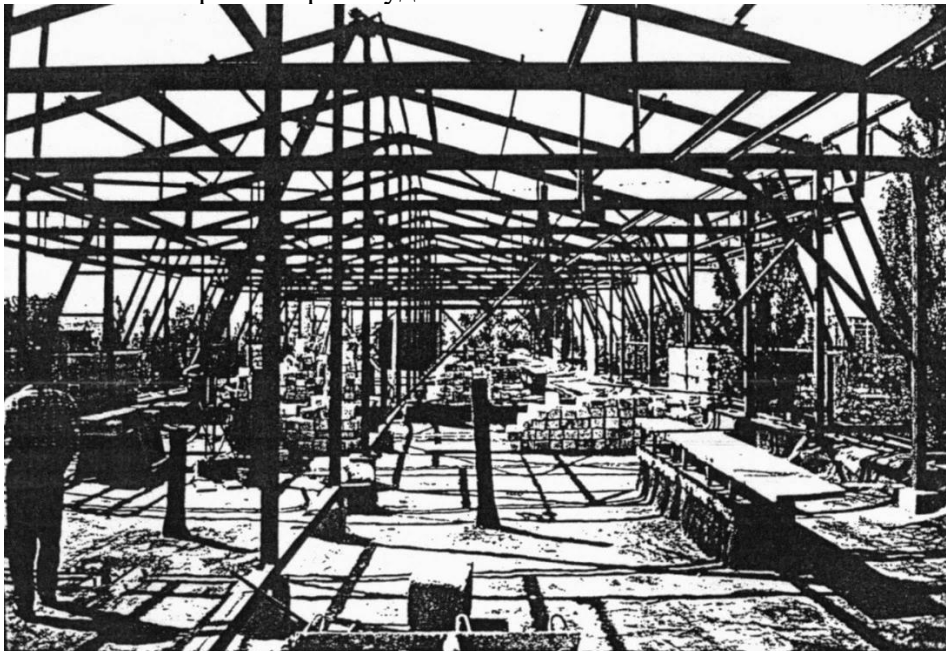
Загальний вид змонтованої частини металевих конструкцій мансарди.
